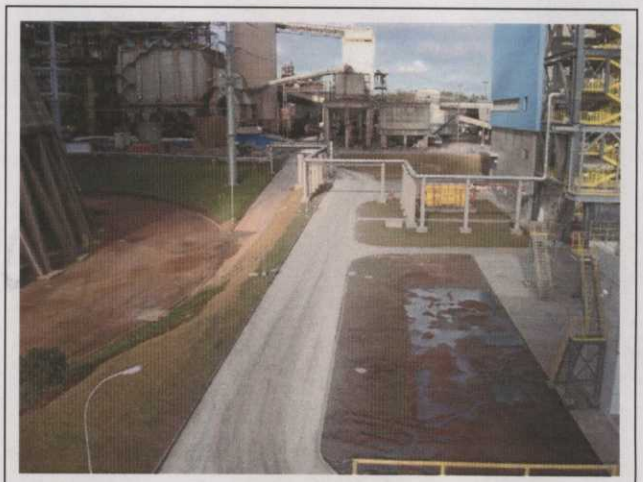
Rua principal de acesso à Fase C/desmobilização do canteiro
